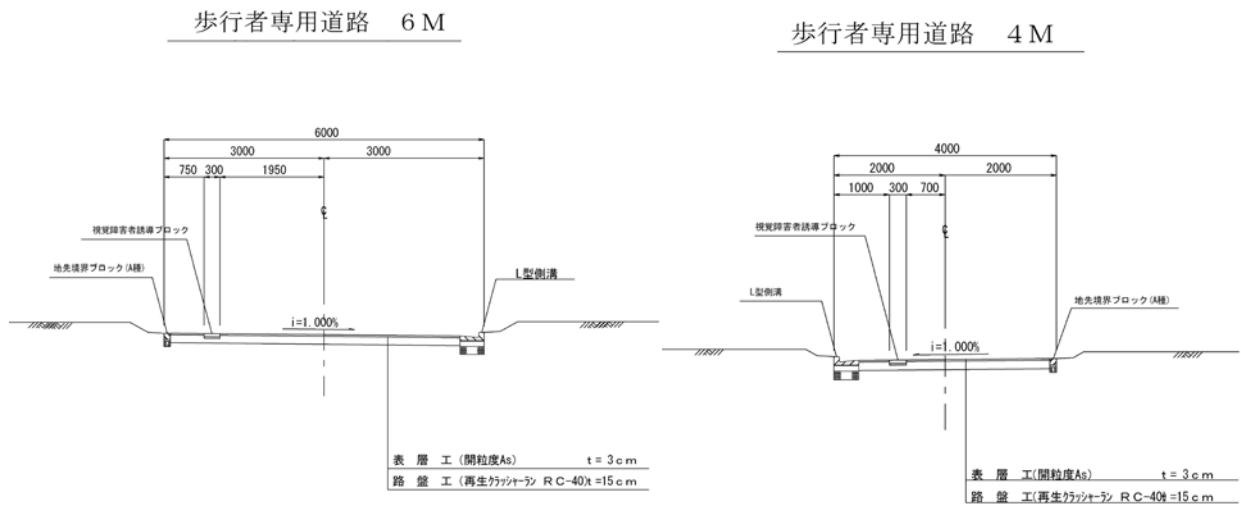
(7) 道路断面図(歩行者専用道路標準断面)
